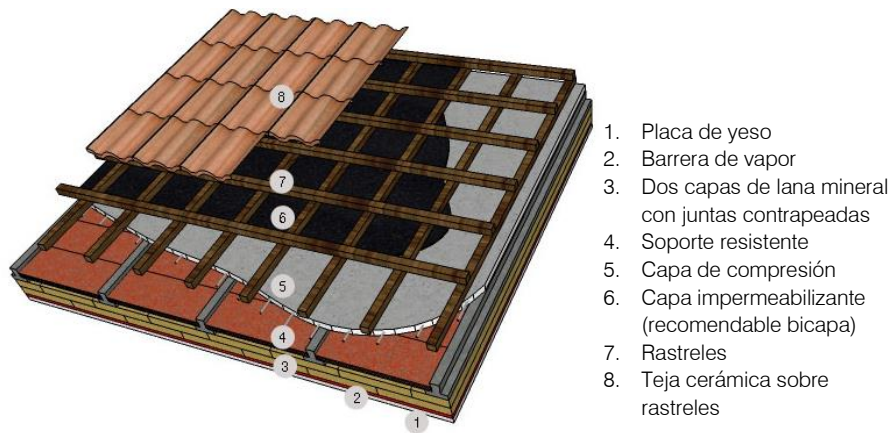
Esquema de cubierta sobre rastreles. Aislamiento por debajo de forjado
